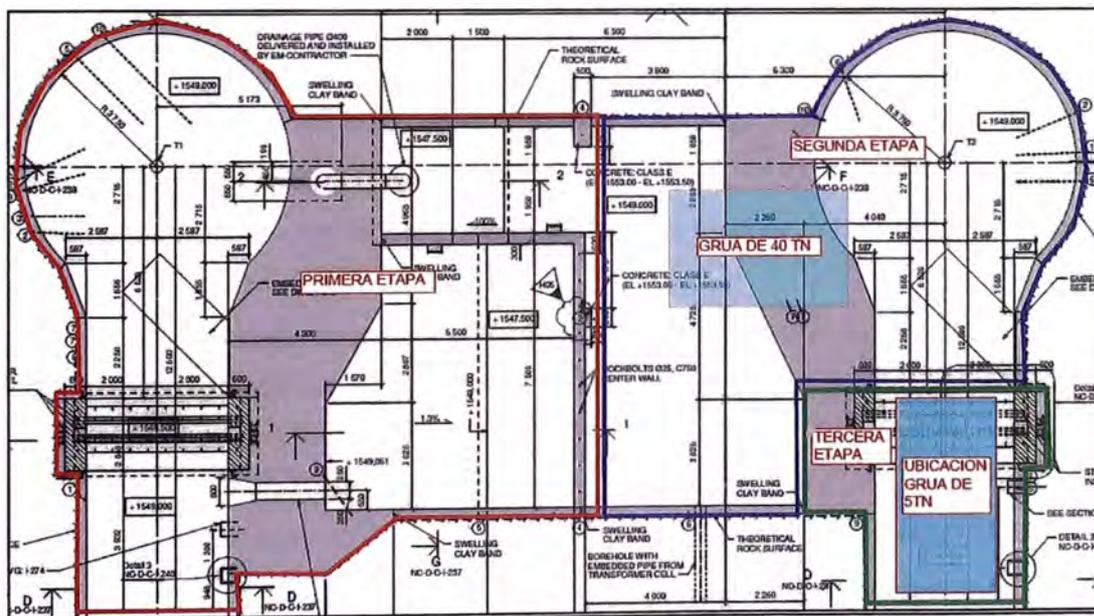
Sectorización de etapas de construcción por falta de puente grúa – Planta nivel 0
